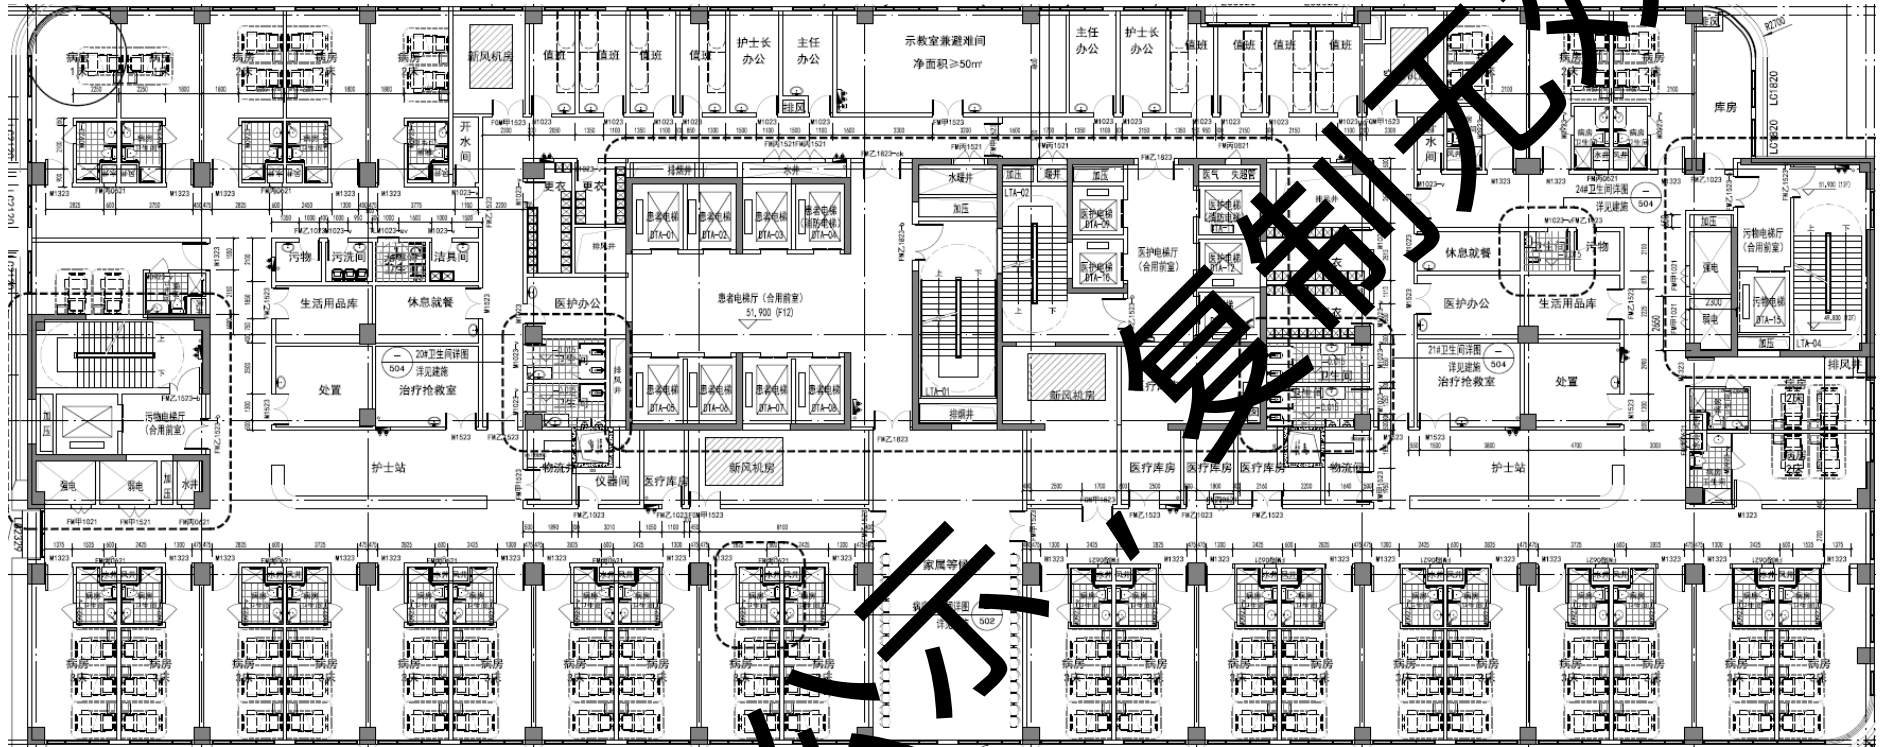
本项目新建住院综合楼 12F 平面布置图
